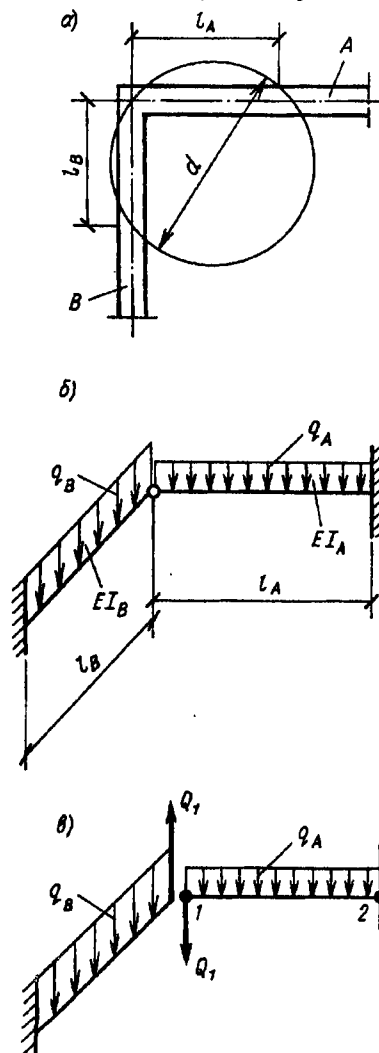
Угловой участок здания: а — план; б — расчетная схема; в — основная система; A и B — продольная и поперечная стены
